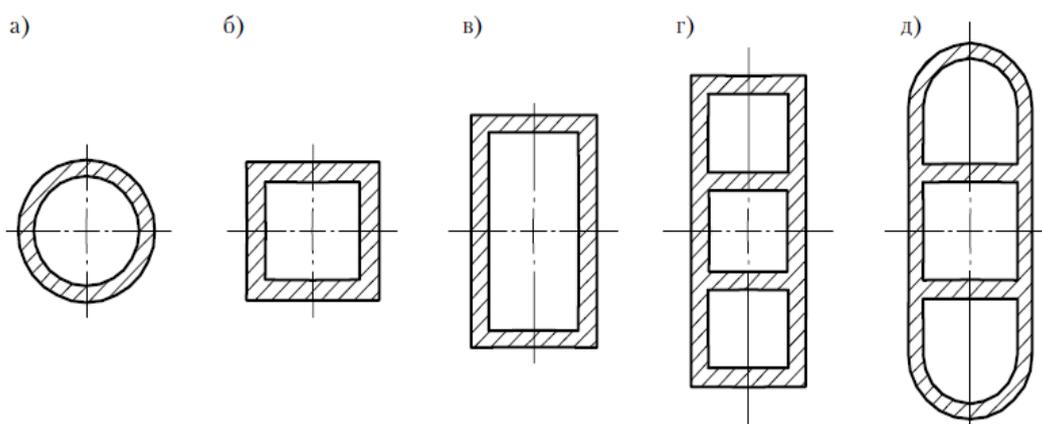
Формы поперечного сечения опускных колодез: а) круглая; б) квадратная; в) прямоугольная; г) прямоугольная с поперечными перегородками; д) с закругленными торцевыми стенками [2]
